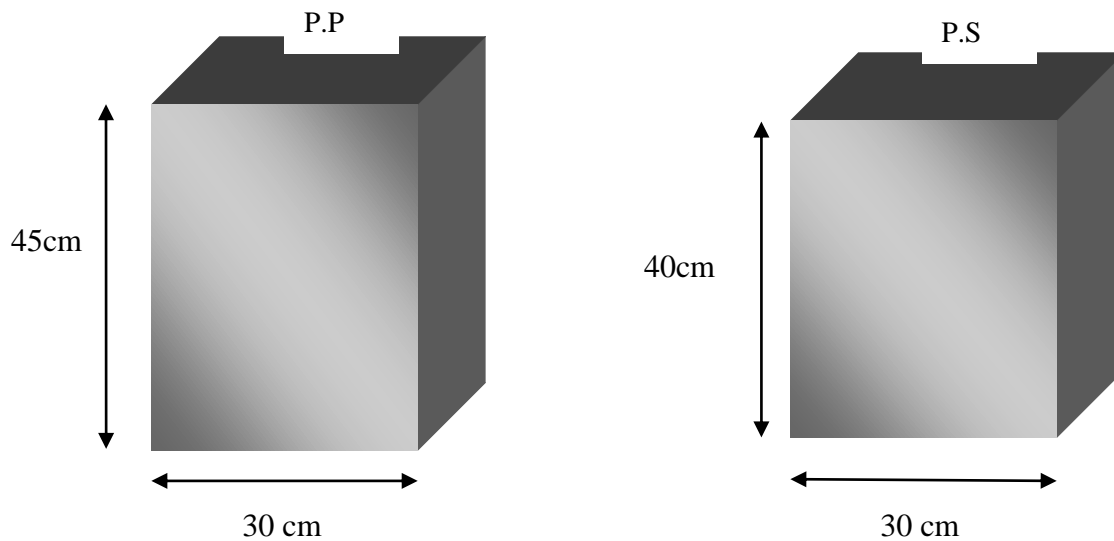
Les dimensions de la poutre principale et la poutre secondaire.
